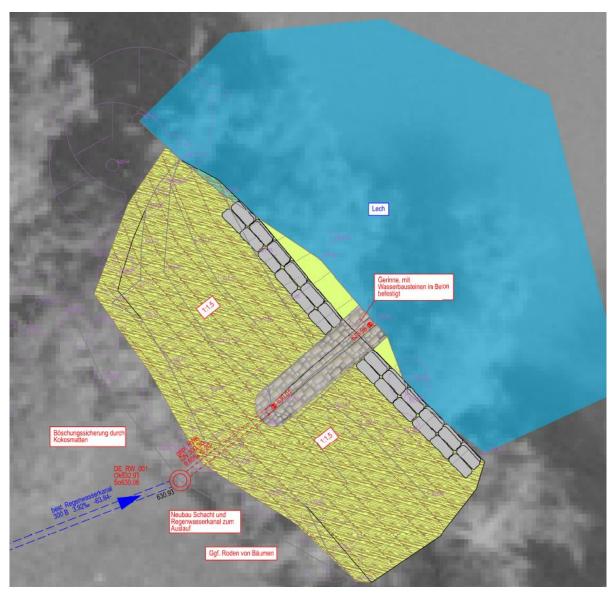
Ausschnitt aus Lageplan 118127-03-HW
